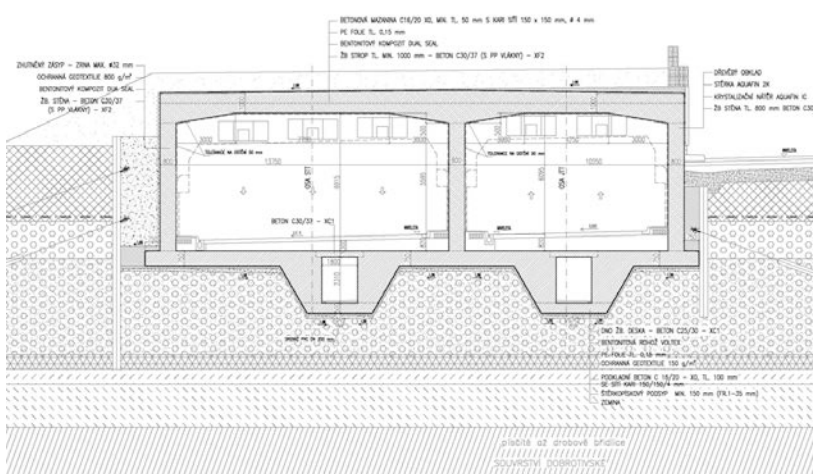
TCB – Sección transversal construida mediante excavación entre pantallas.
